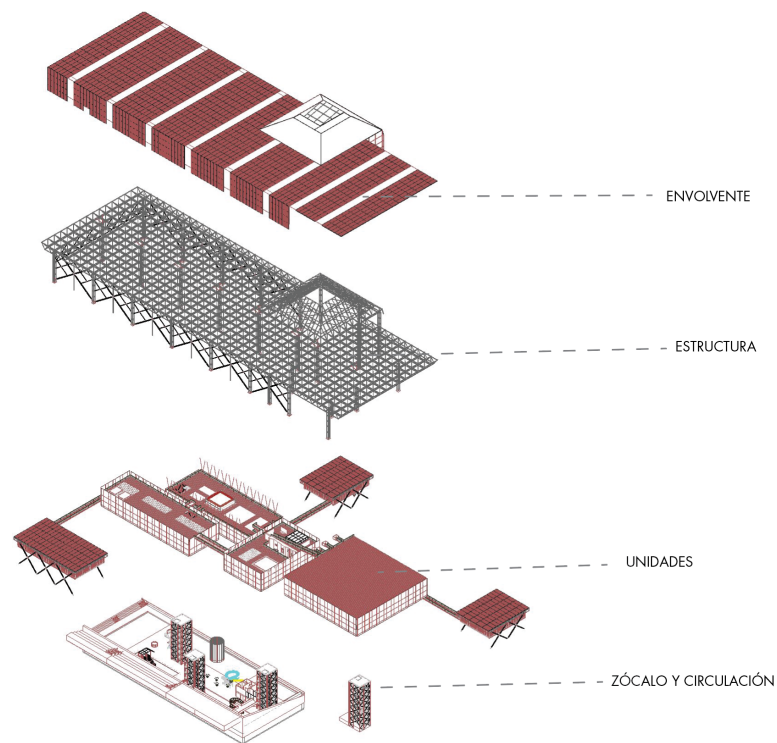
Capas desarrolladas en proyecto. Elaboración propia.
